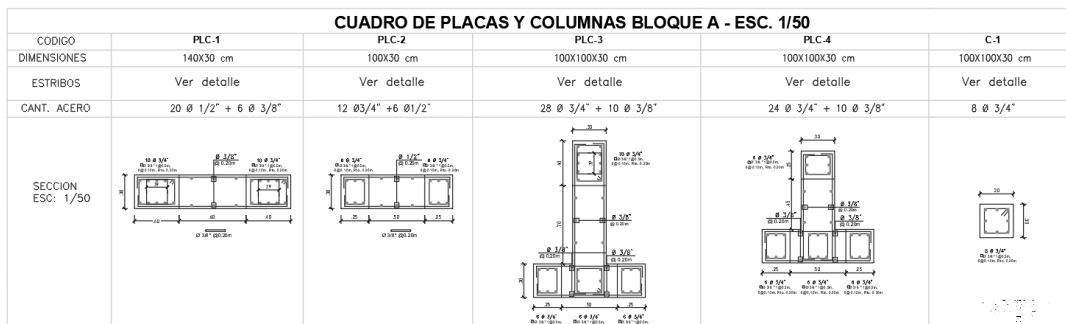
Predimensionamiento de placas y columnas - Bloque A
